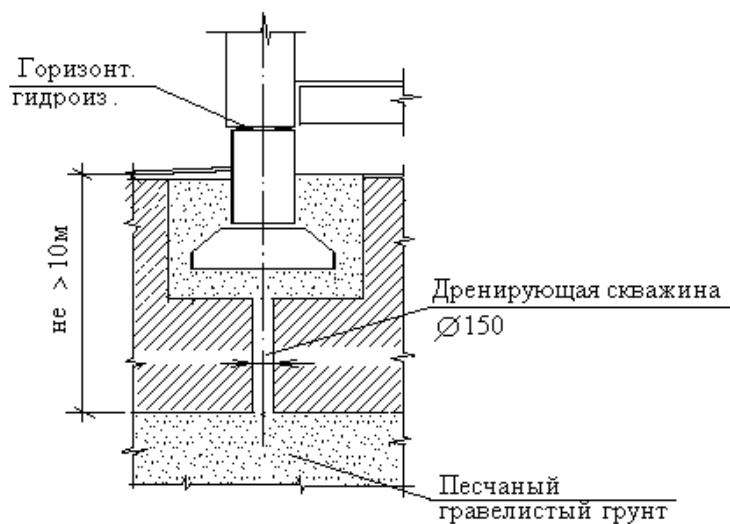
Сечение малозаглубленного фундамента по дренирующей скважине при толщине глинистых грунтов не более 10 м
